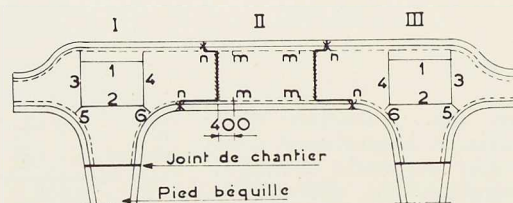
Schéma montrant la succession des joints soudés.
